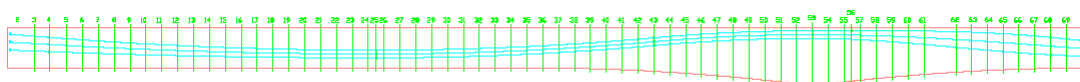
Traçado do pré-esforço para o primeiro tramo [28].
